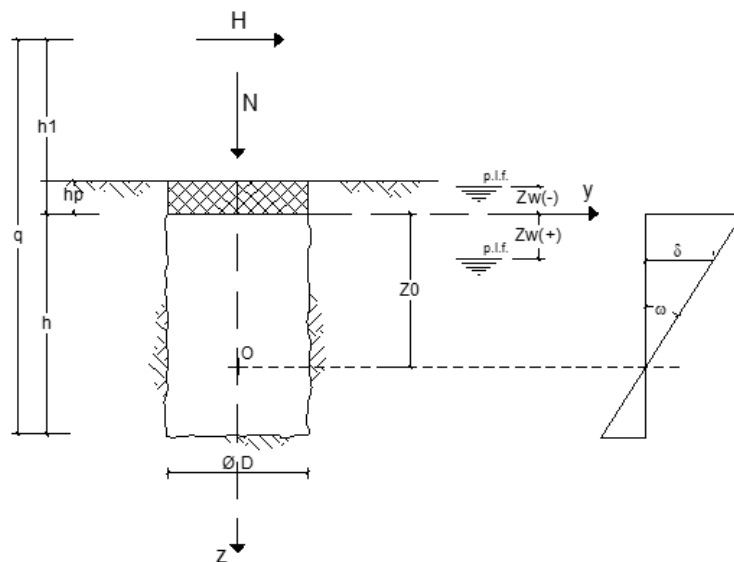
Schematizzazione del problema di fondazione a pozzo [15]
